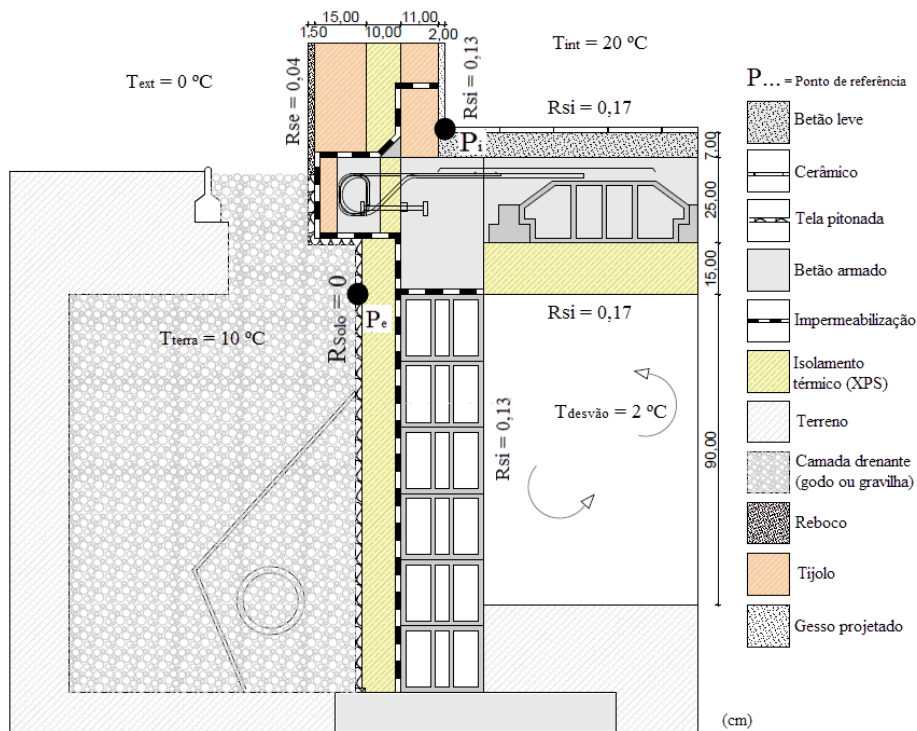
Ligação de fachada (parede dupla) com laje de piso sobre desvão ventilado
